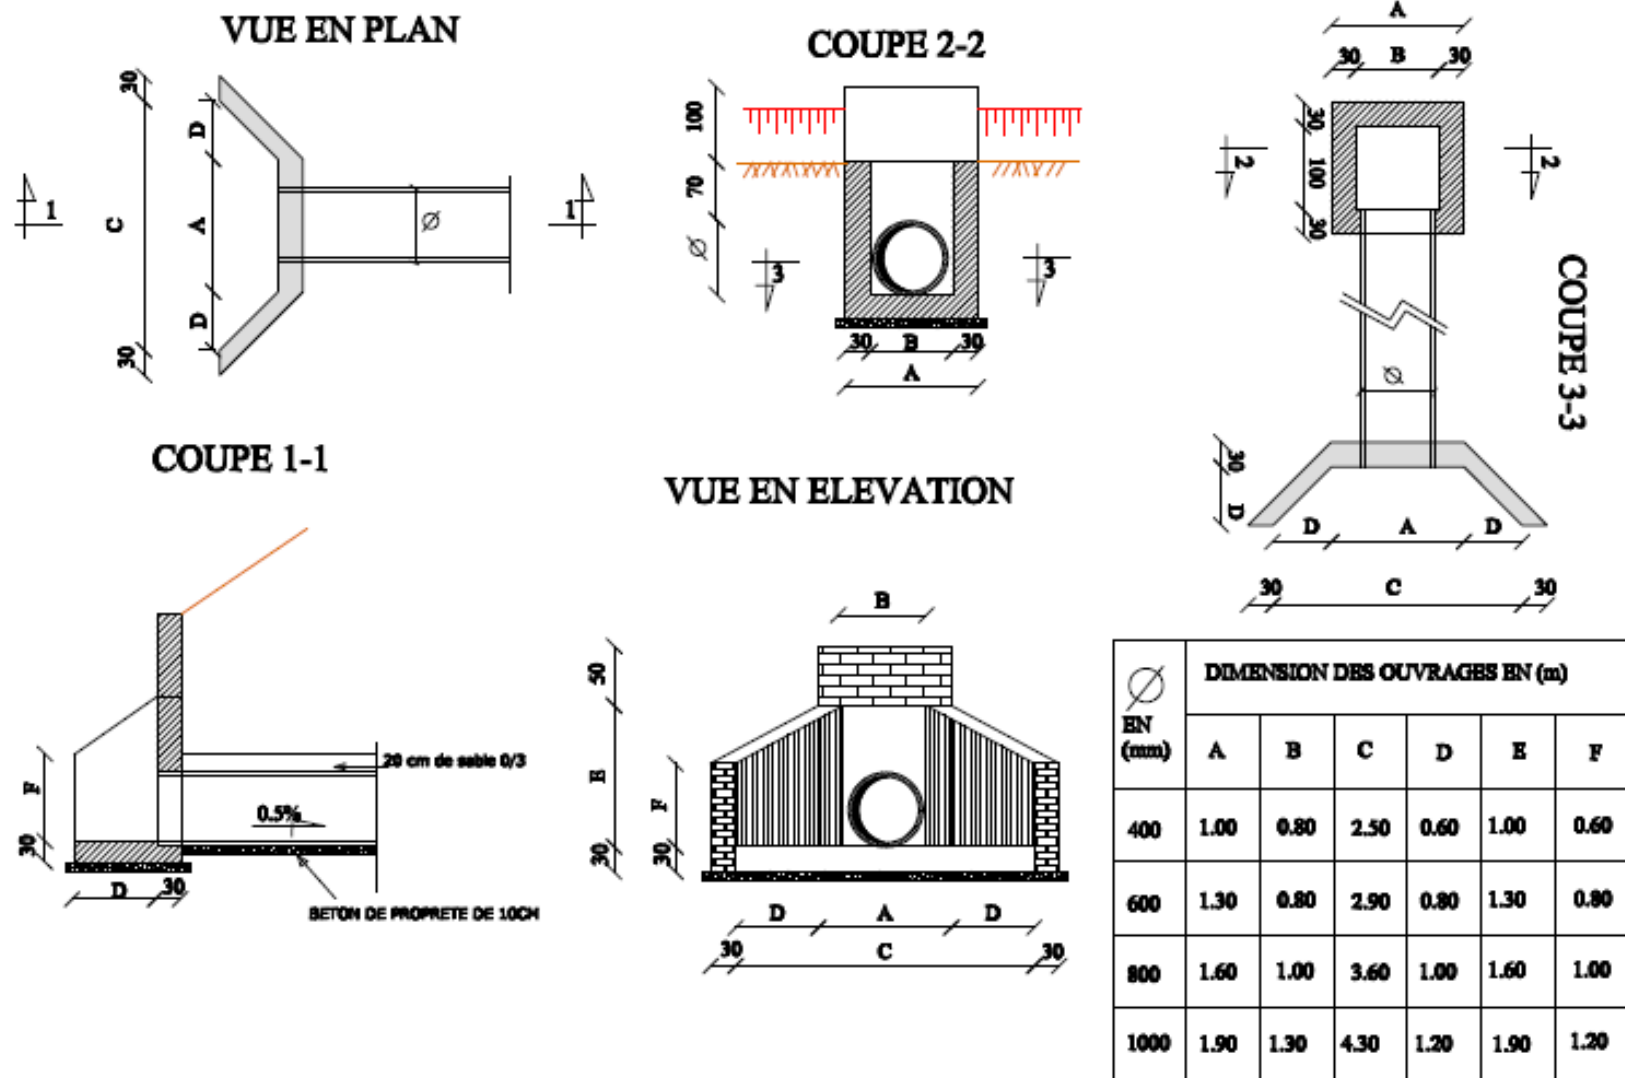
Détail sur Ouvrage Busé en Béton [1]
